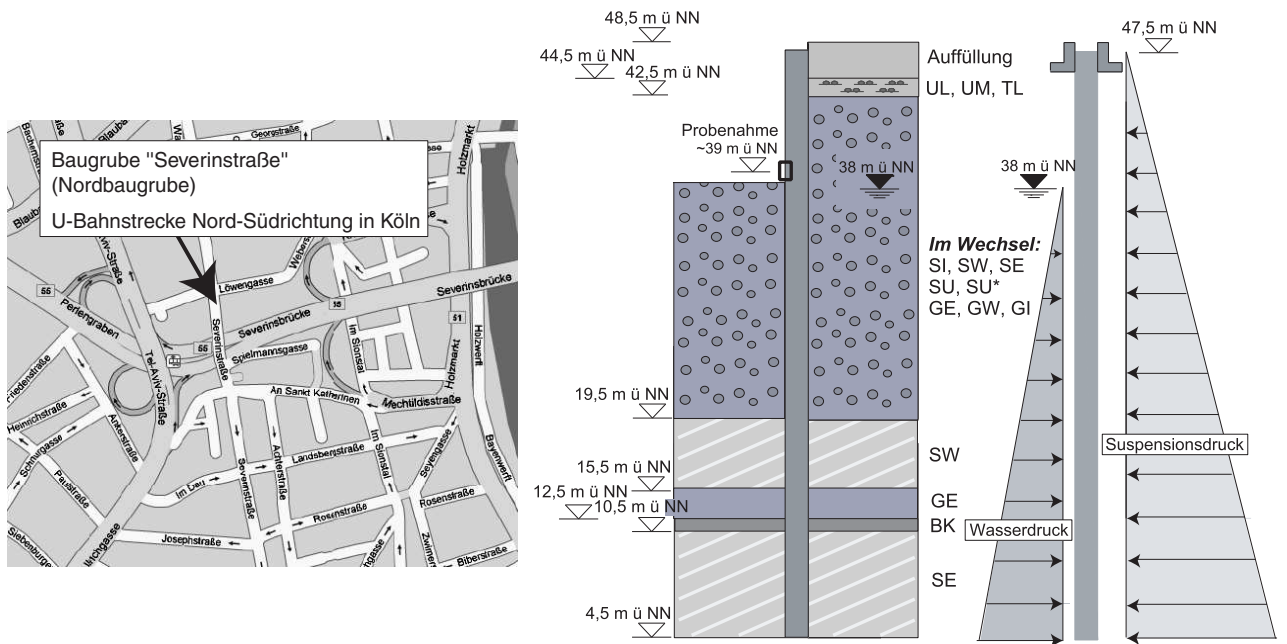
Lageplan der U-Bahn-Baugrube "Severinstraße" (Köln)
